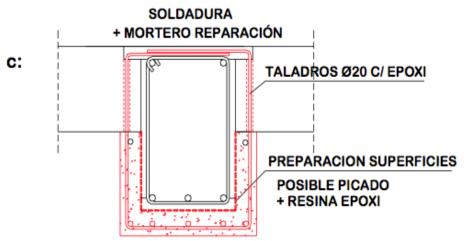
Armados para refuerzo de vigas caso c. (Fuente: Patología, reparación y refuerzo de estructuras de hormigón armado de edificación)
